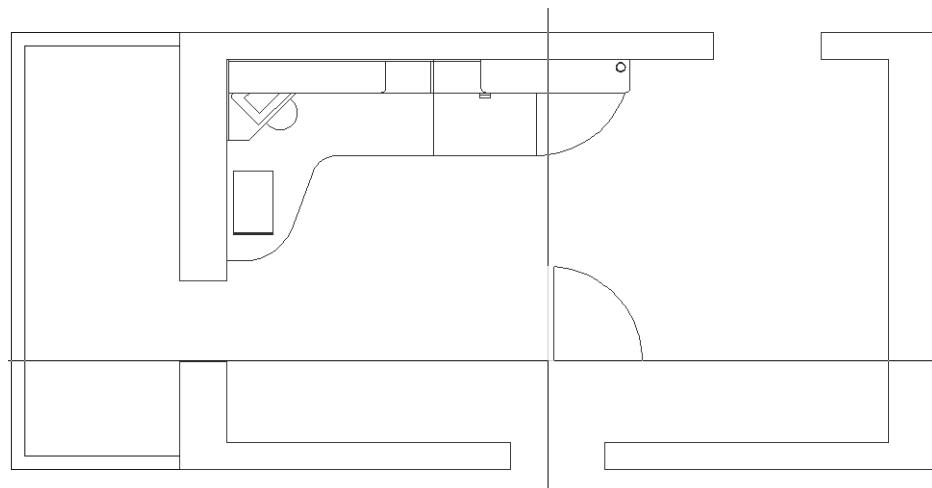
▼ Вставка ссылки на блок Дверь 700 в чертеж
